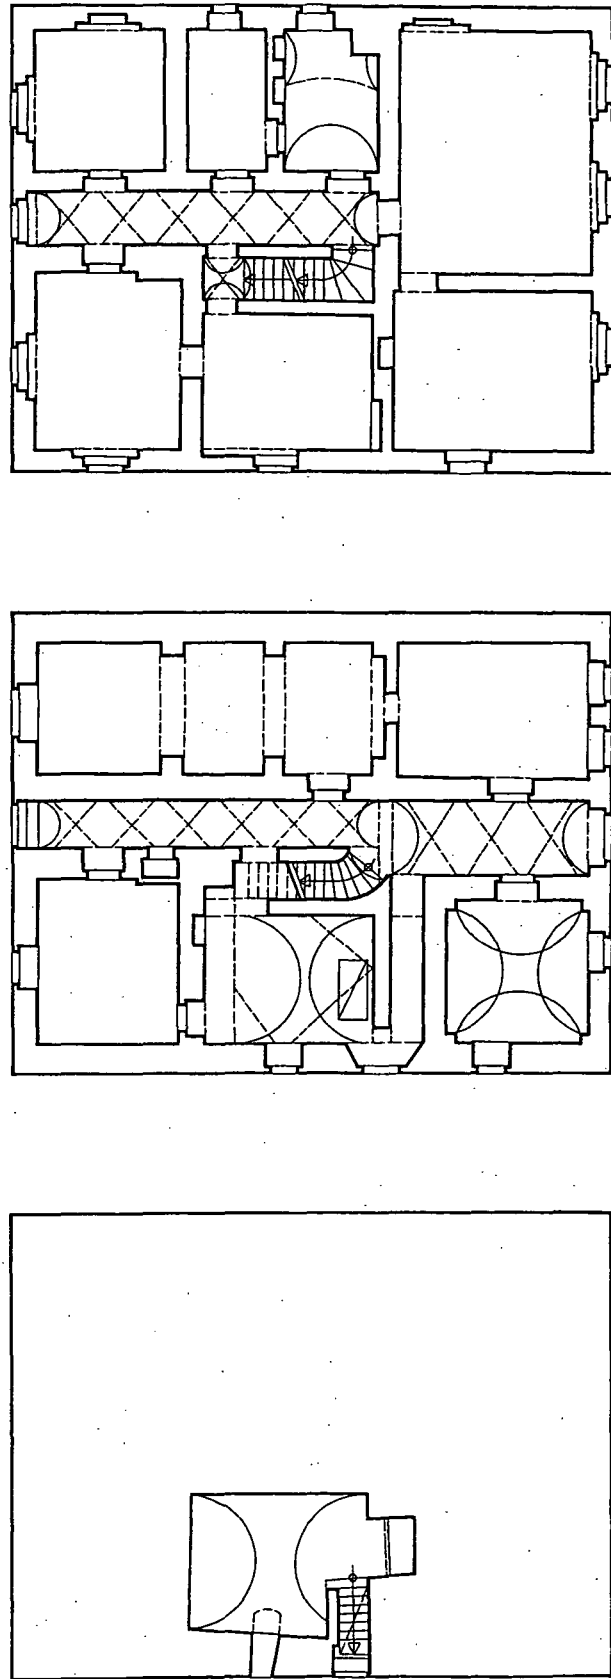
Schiferplatz 5 – Grundrisse Keller, Erdgeschoss, Obergeschoss (1:200).
